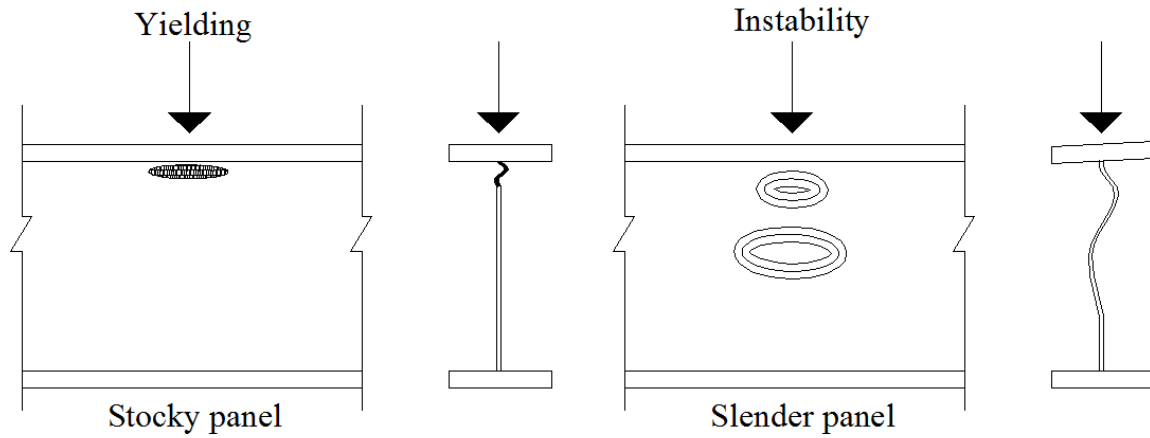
Modos de falla de vigas armadas frente a cargas concentradas (Patch loading). Chacón (2009)
